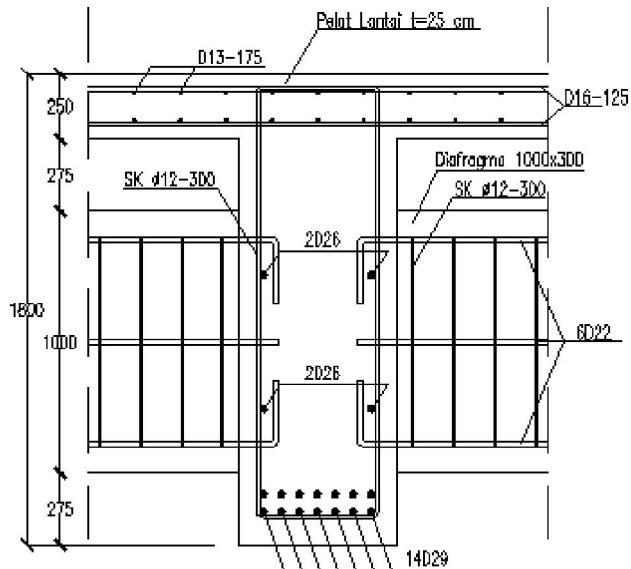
25. Rekap Perhitungan Girder Tengah
